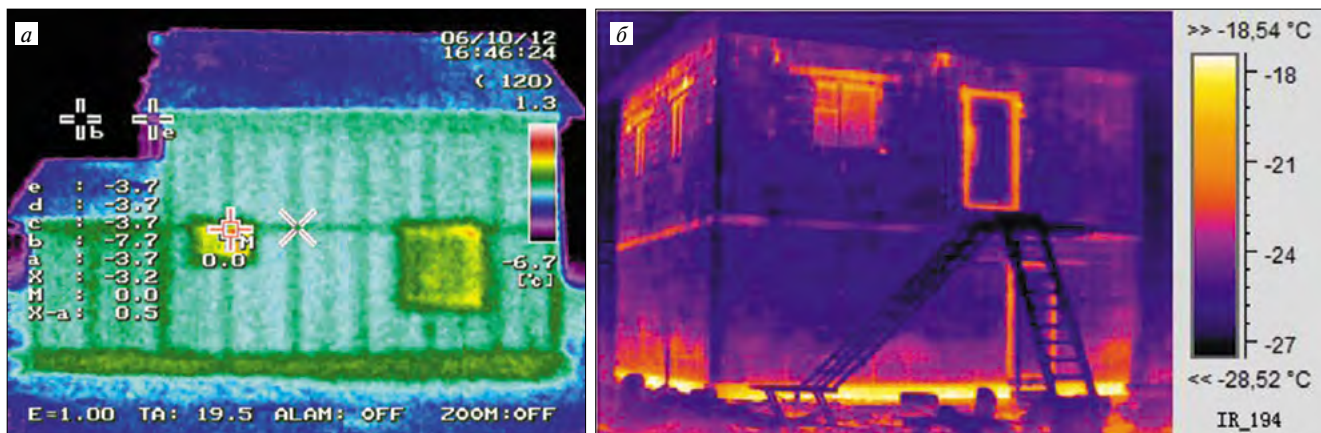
Тепловизионные снимки фасада: а – жилого дома № 2; б – жилого дома в СОТ «Мечта»
